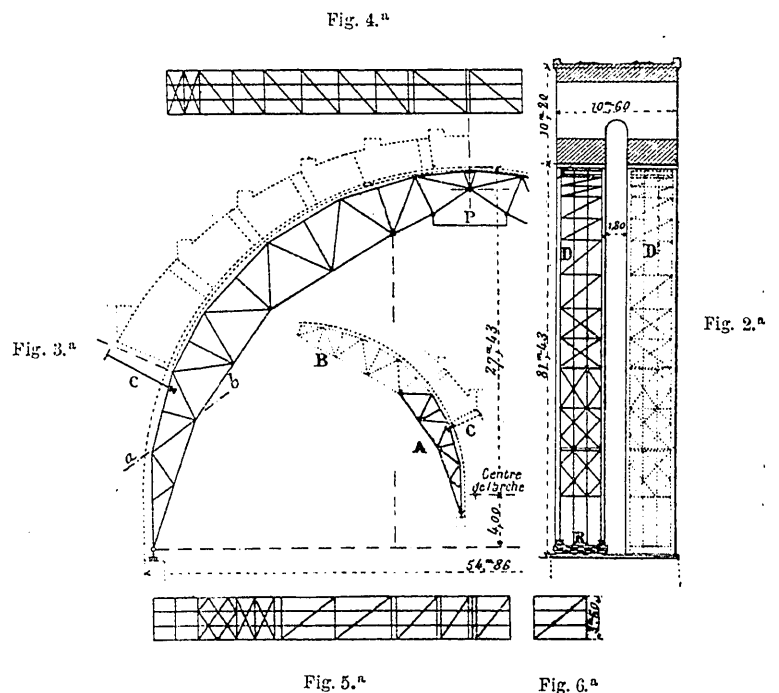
^a—Vista del arriostramiento de la viga superior.
